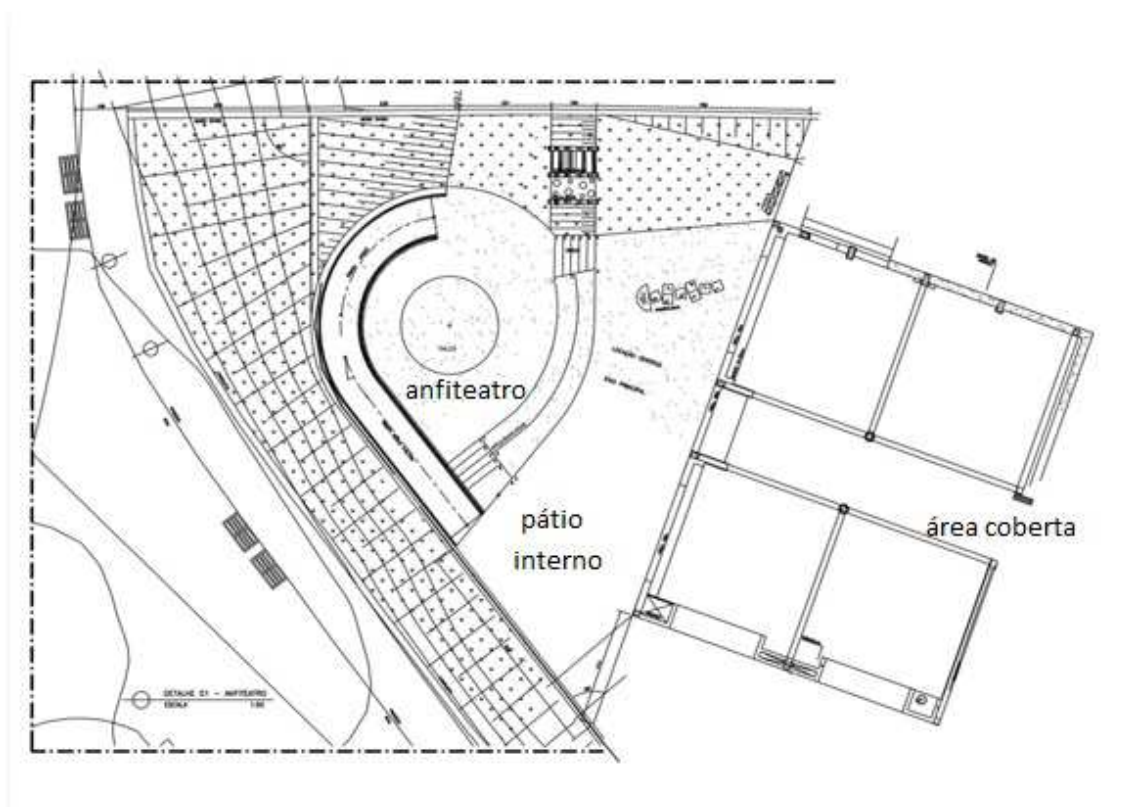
Planta baixa do pátio interno e anfiteatro
